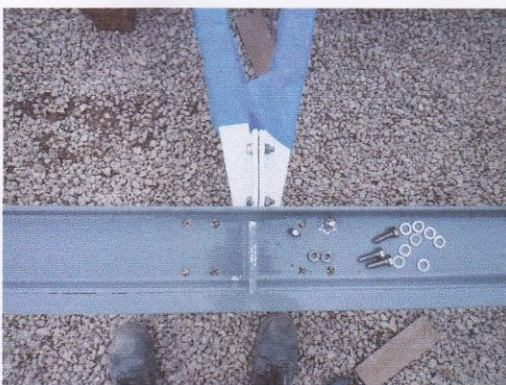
(02/03/11): tirante colocado para reforzar la sujeción del saneamiento de residuales colgado en la planta baja de ambos edificios.
